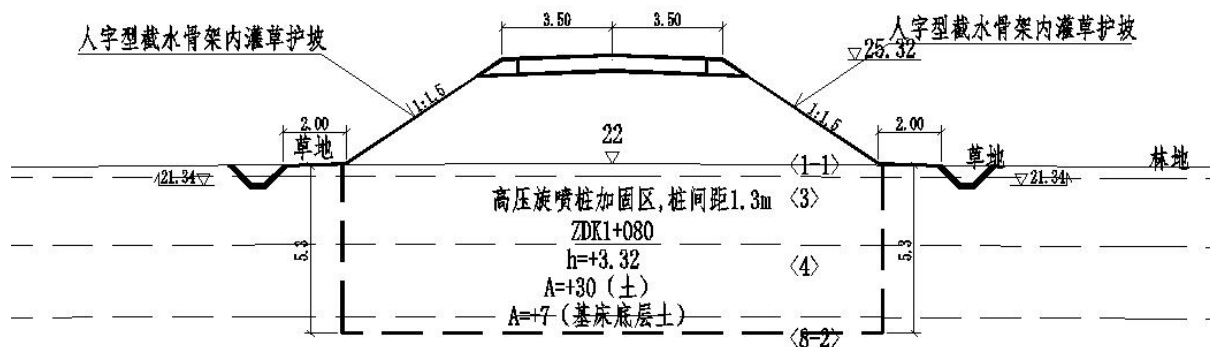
新建区间线路高压旋喷桩处理代表性横断面图
